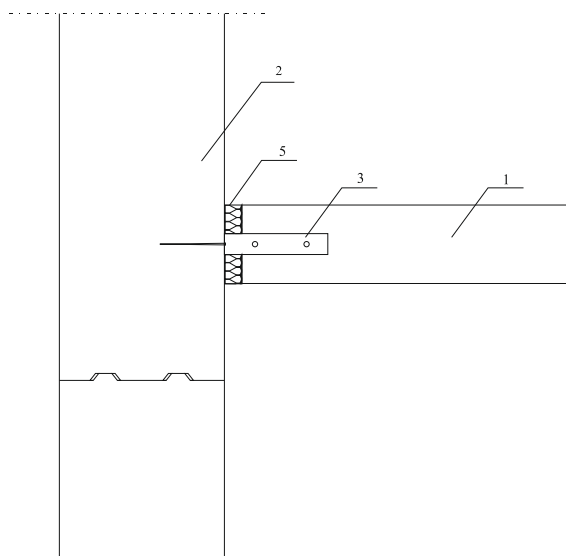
Соединение противопожарных стен с поперечными стенами
